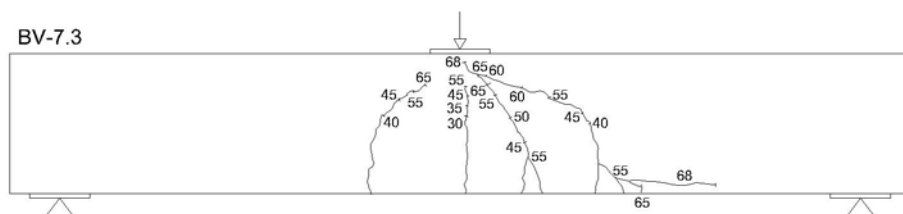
Rissbild BV-7.3 mit Laststufen
